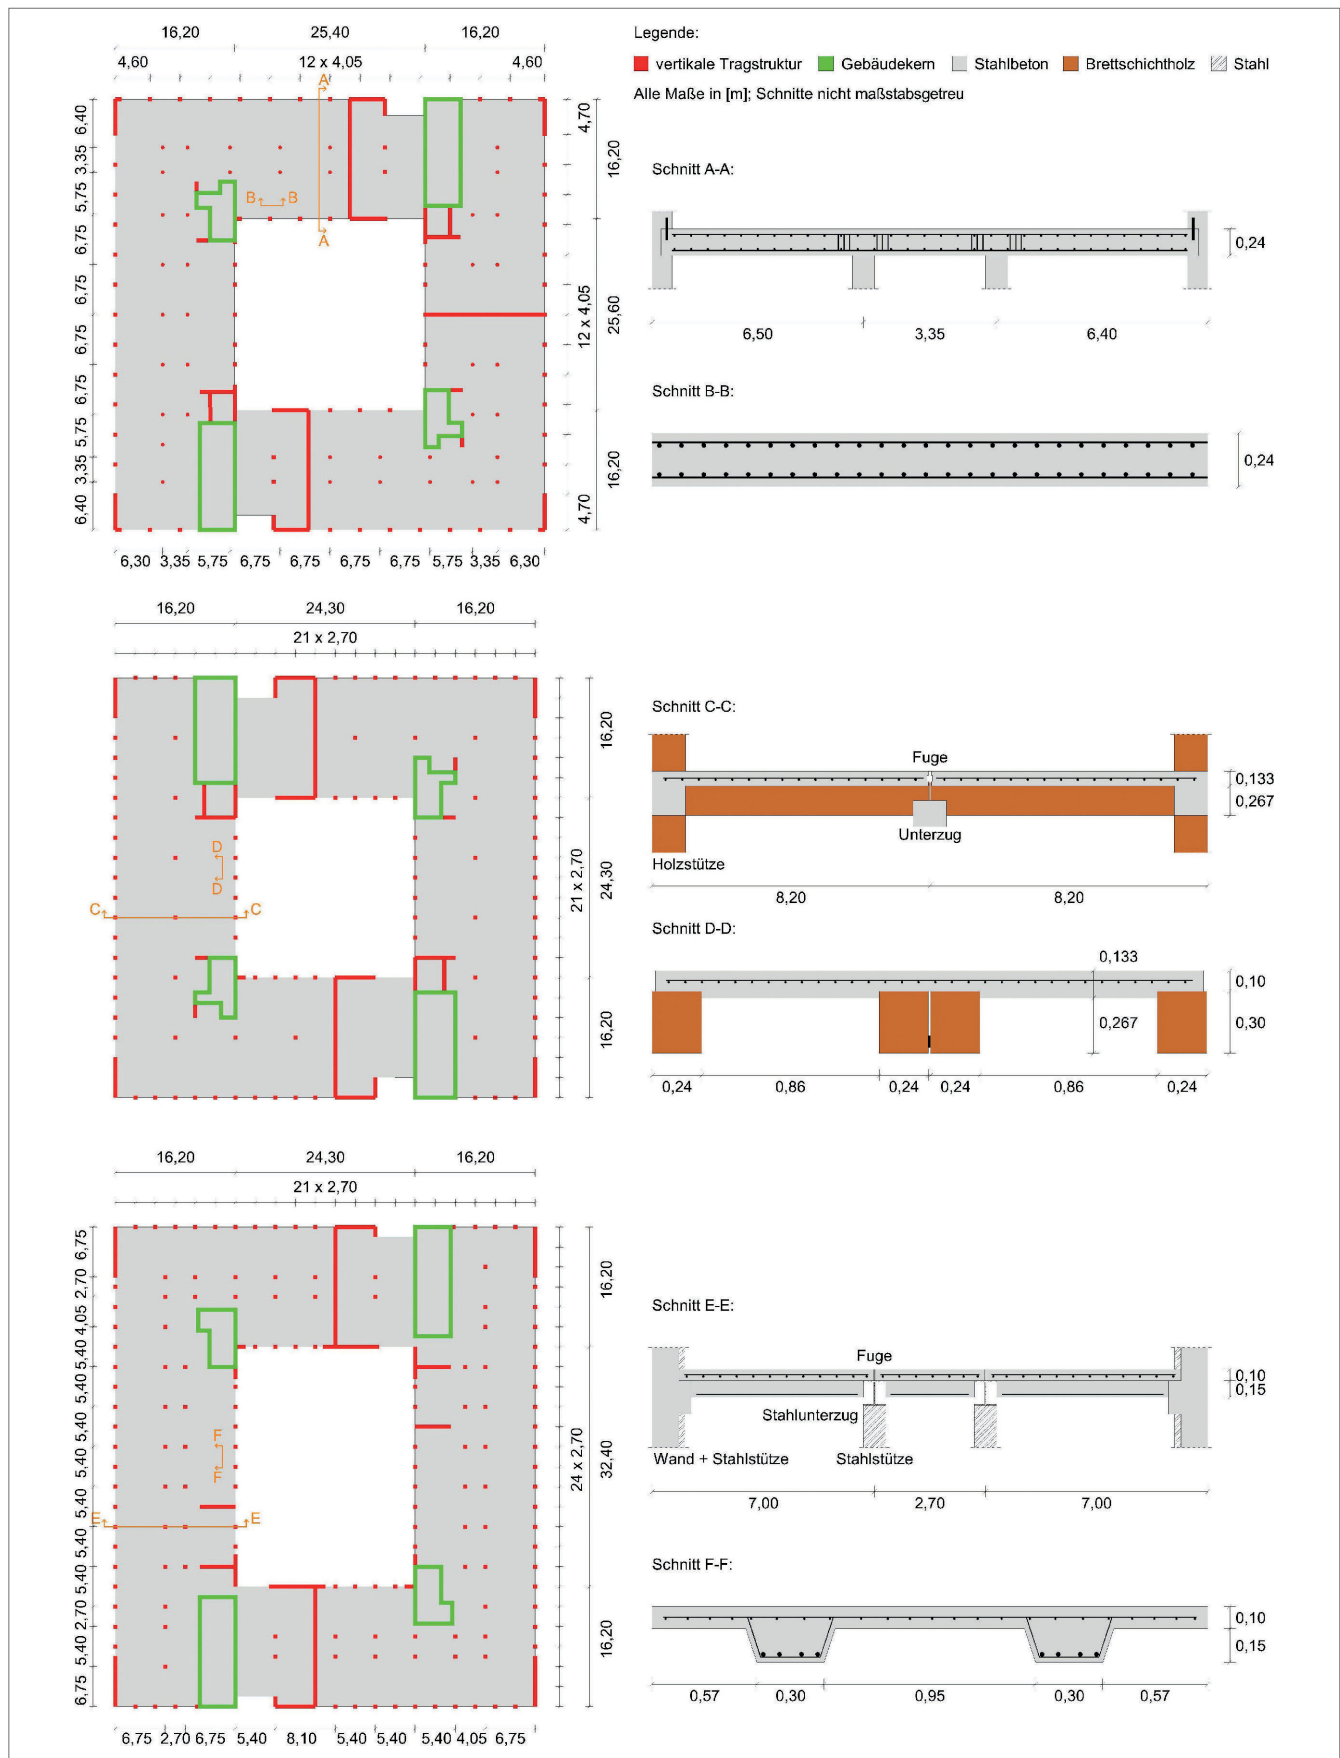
Grundrisse und Schnitte der Gebäude G1 (oben), G2 (Mitte) und G3 (unten) schematisch *Grafik: RPTU
